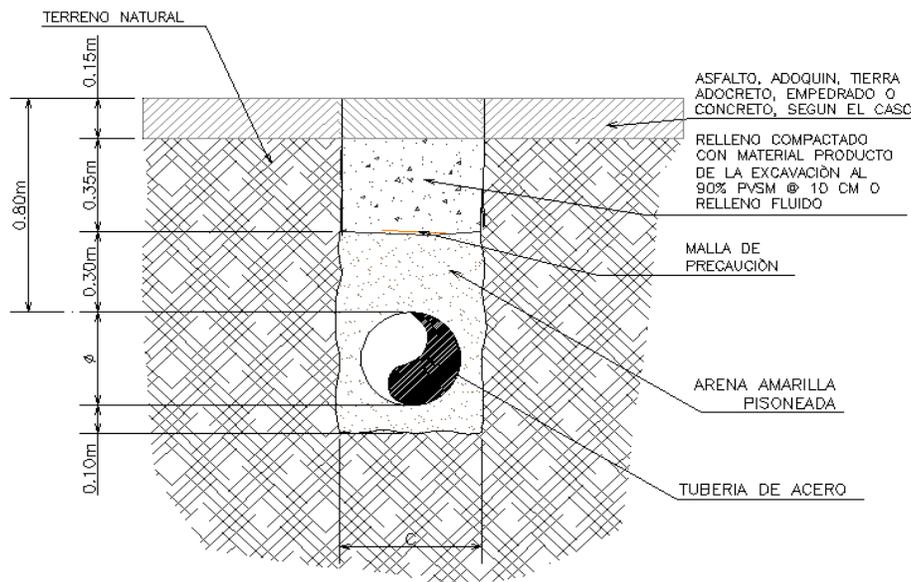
Esquema general del diseño de las zanjas para la instalación de tubería.
